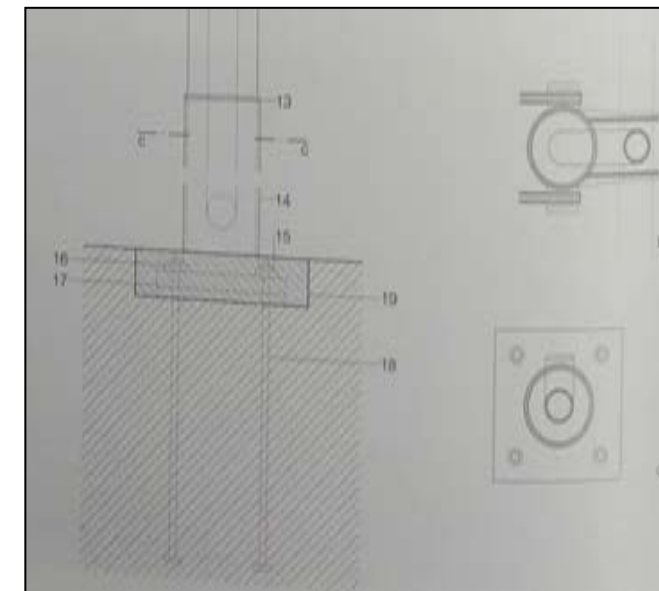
assemblé de poteau en B.A avec poteau arborescent tubulaire
